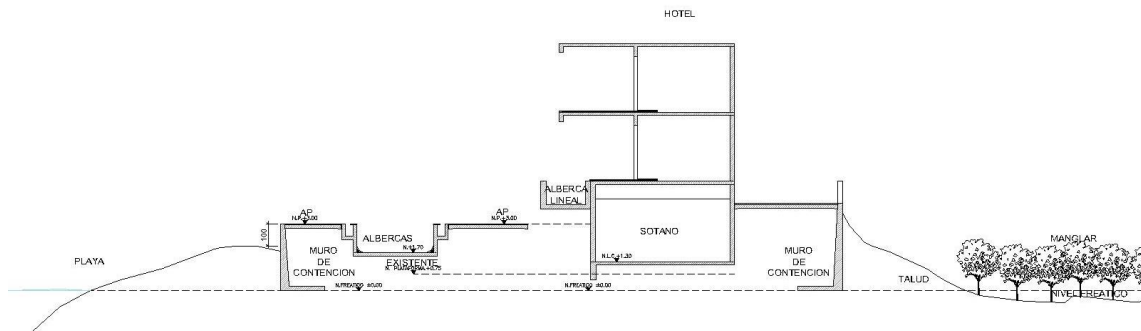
Diseño de sembrado de obra en la zona costera, mostrando los niveles de los elementos constructivos y naturales. Fuente: Promovente.
